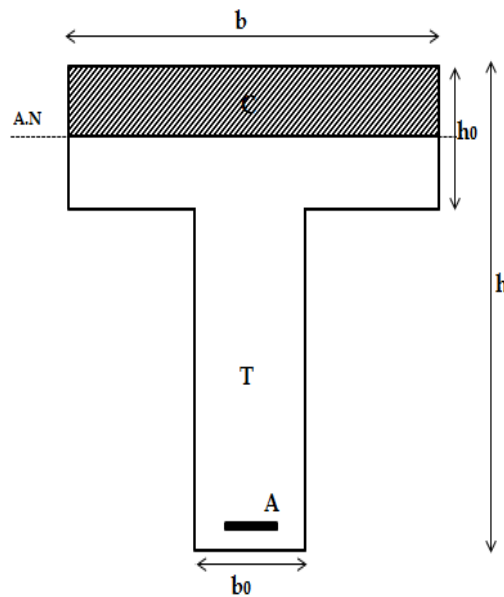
La section de la poutrelle en travée sollicitée à la F.S
